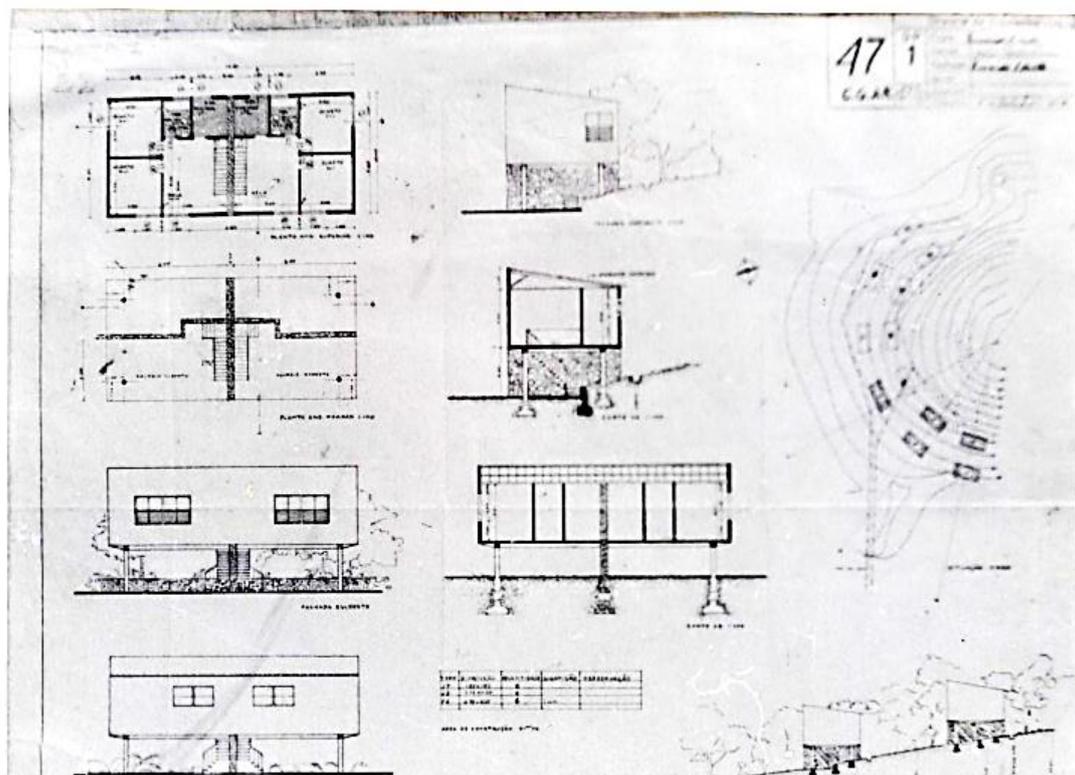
Leprosário da Mirueira, casas geminadas, Diretoria de Arquitetura e Urbanismo, 1936 (plantas, cortes, fachadas).
